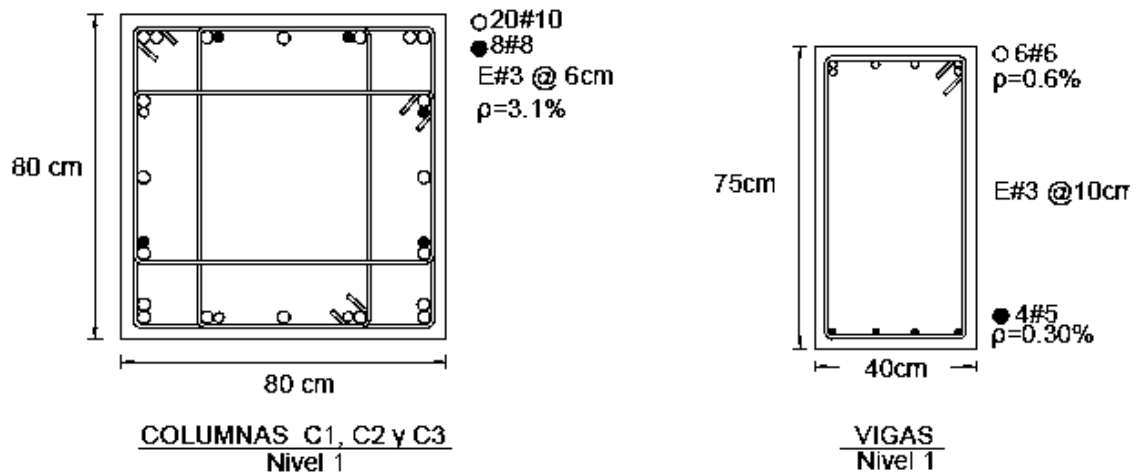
Armado de vigas y columnas diseñadas con las NTCC-17 para el edificio de 6 niveles cuyo sistema estructural consiste en marcos dúctiles y muros diafragma de mampostería agrietada
